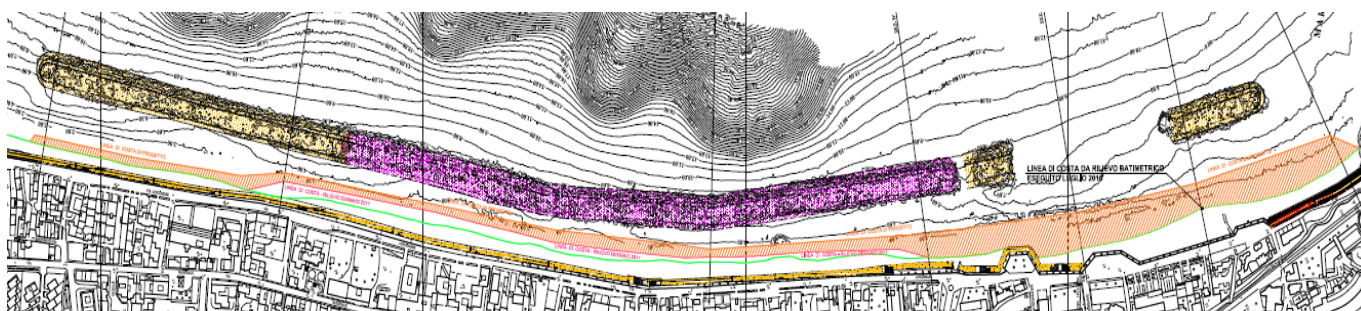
Planimetria di progetto con indicazione del ripascimento previsto sul litorale di S. Alessio Siculo
